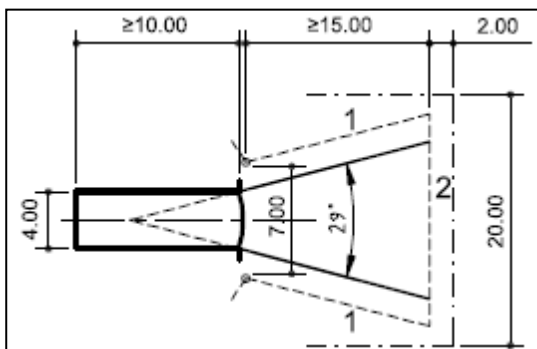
Installation d'entraînement, lancer du javelot (Dimensions en m)
